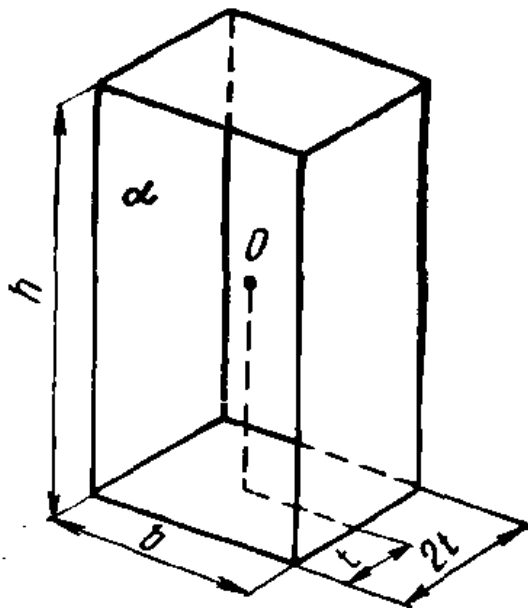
К расчету звукоизоляции прямоугольной частично открытой переговорной кабины
